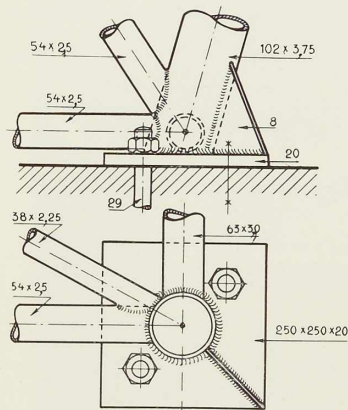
Assemblage réalisé à la base d'une charpente tubulaire soudée.
